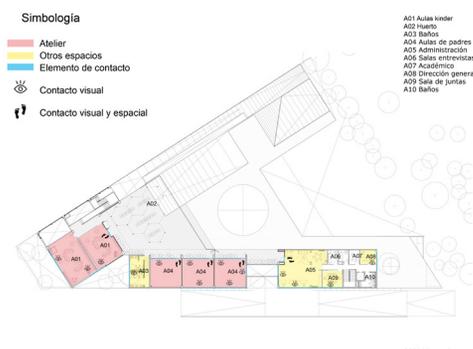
Planta arquitectónica segundo nivel Preescolar Beelieve
